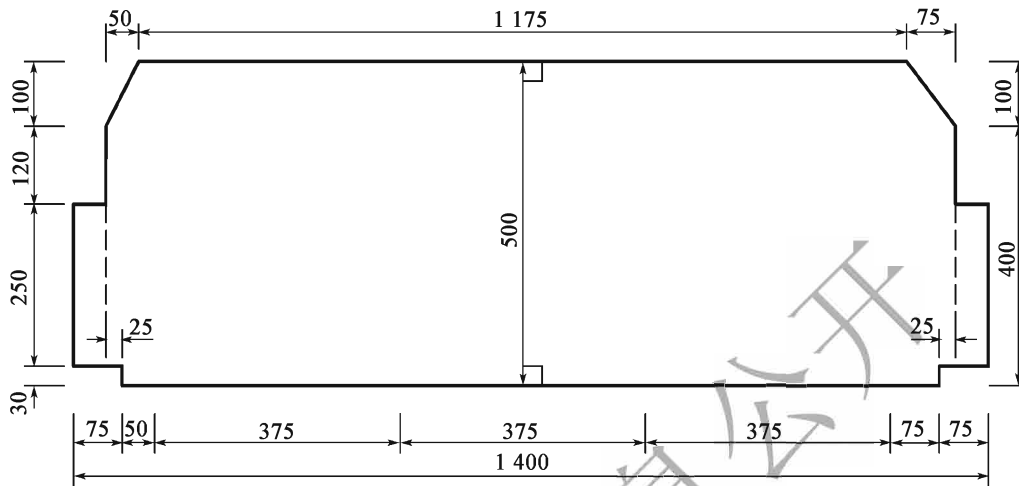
Dégagement de construction du tunnel autoroutier et du tunnel routier de première classe à trois voies(80km/h) (unité:cm)
